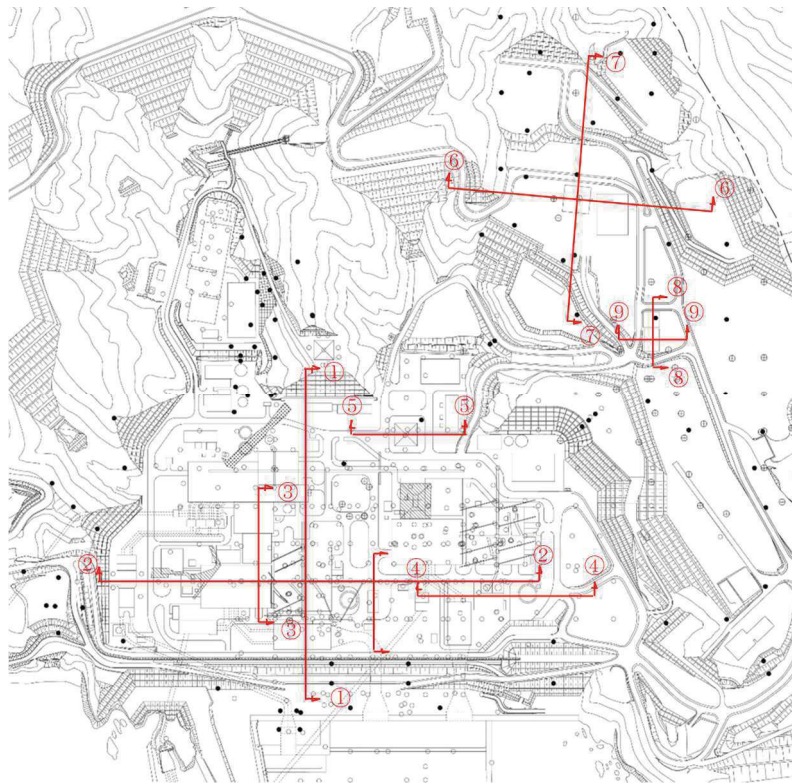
(1) 地質断面图位置 (①-①断面~⑨-⑨断面)
